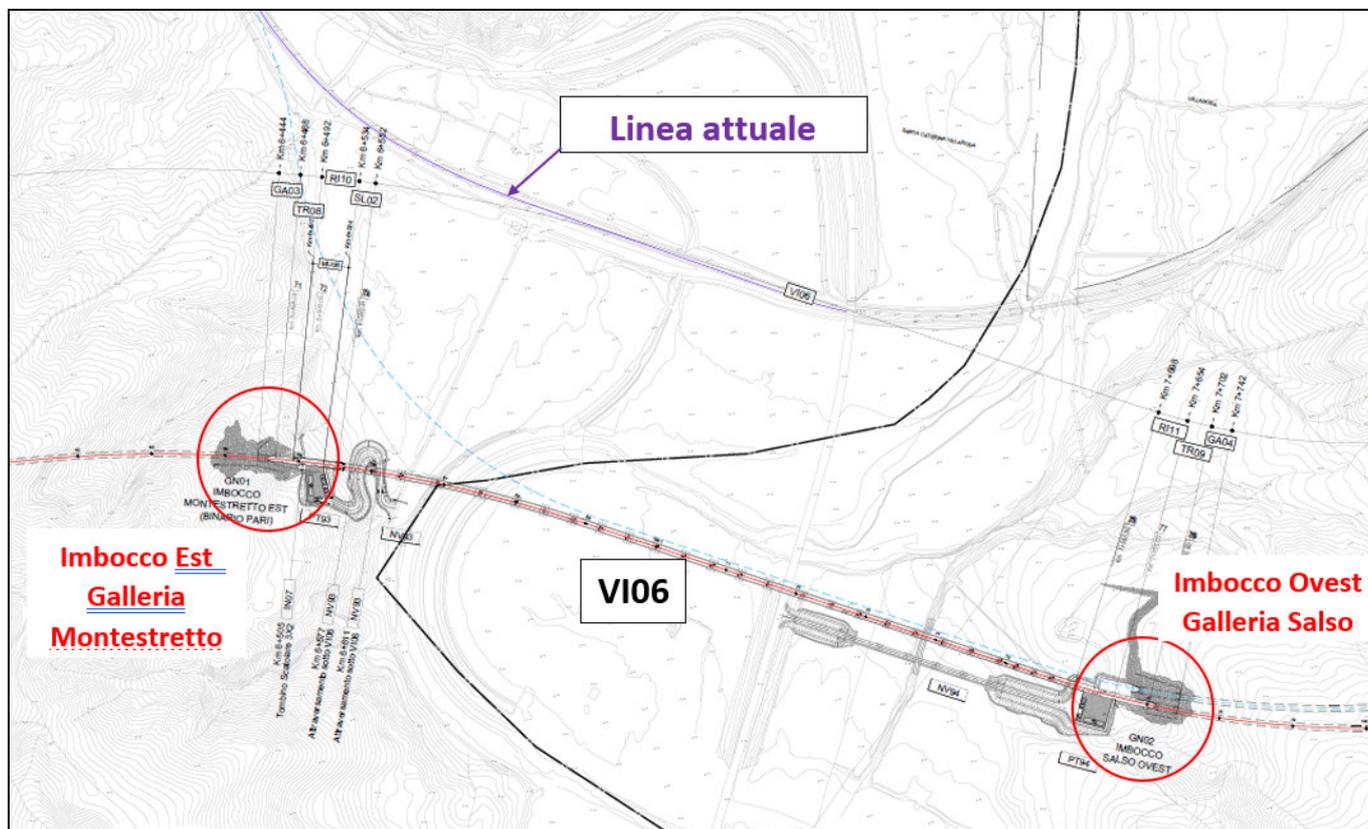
Inquadramento da Imbocco Galleria Monte Stretto a Imbocco Galleria Salso
